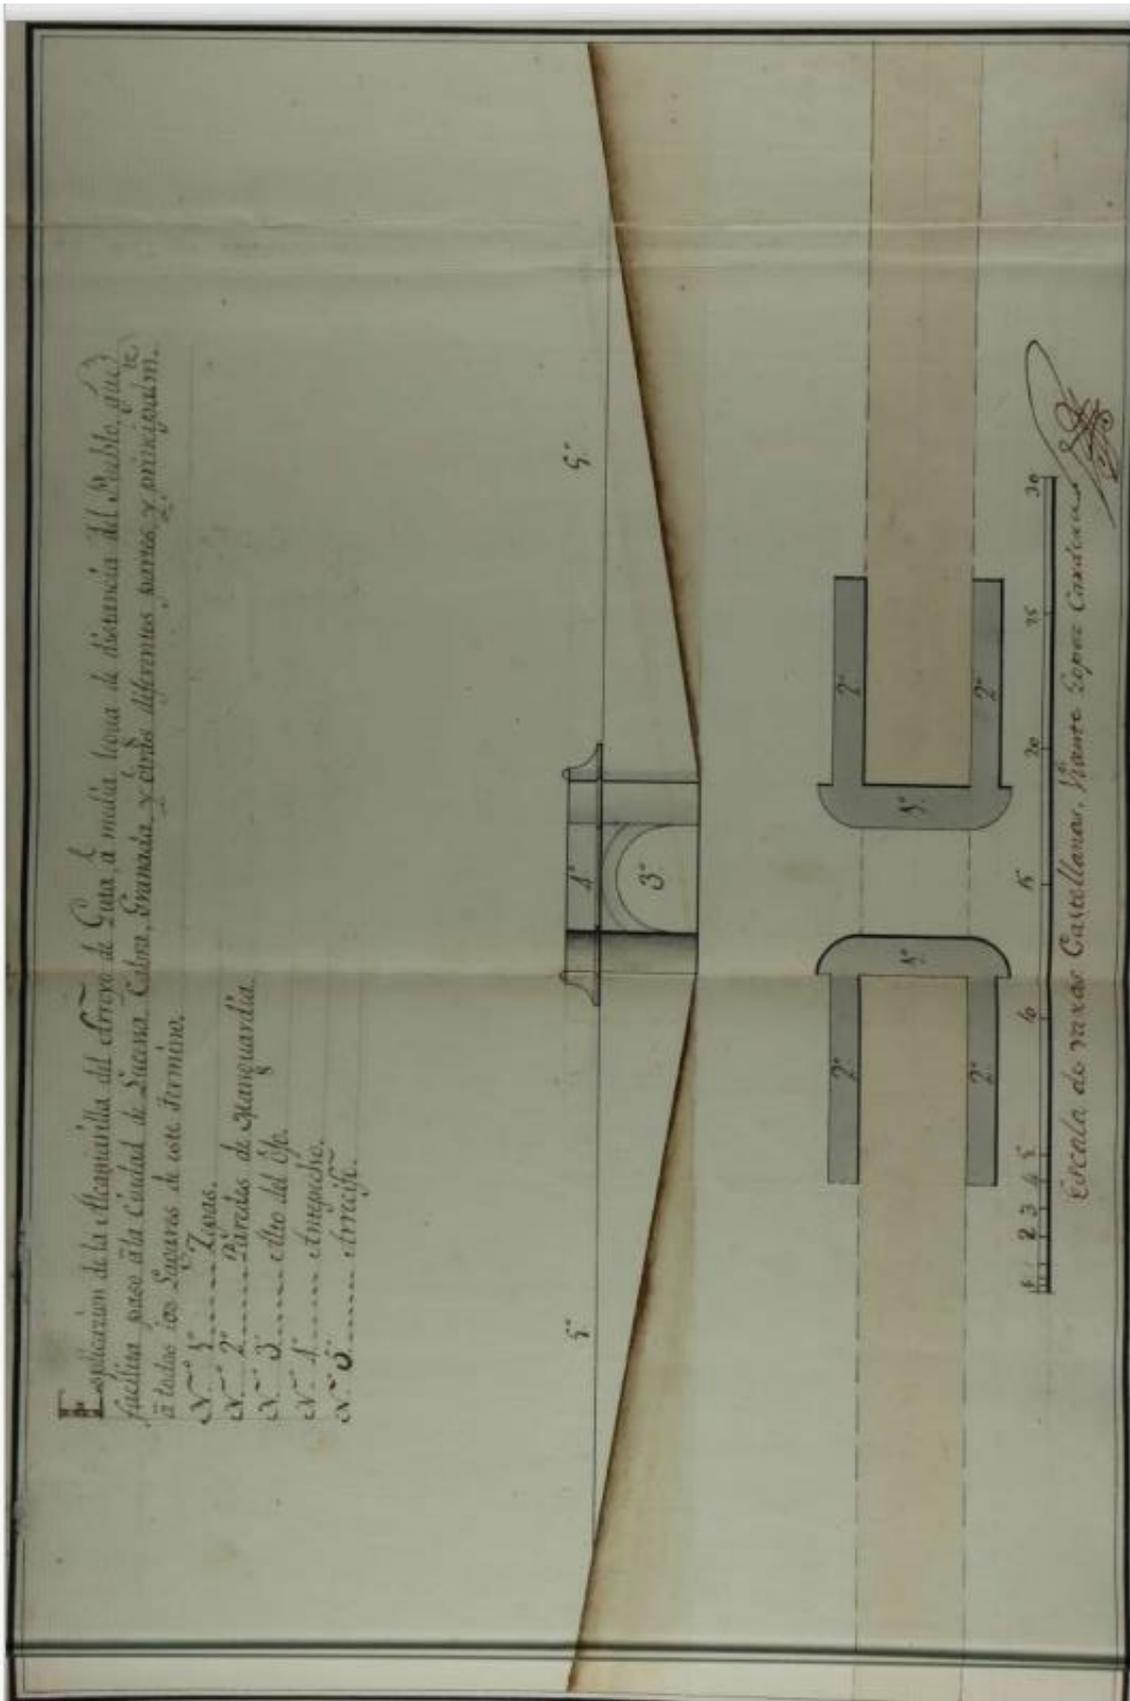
Planta y alzado de la alcantarilla sobre el arroyo de Guta. Vicente López Cardera, 1794.
